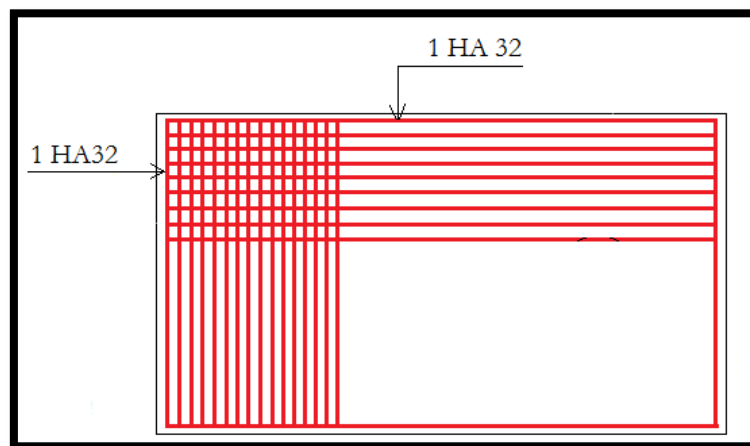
Ferrailage de la nappe inférieure de la semelle.
